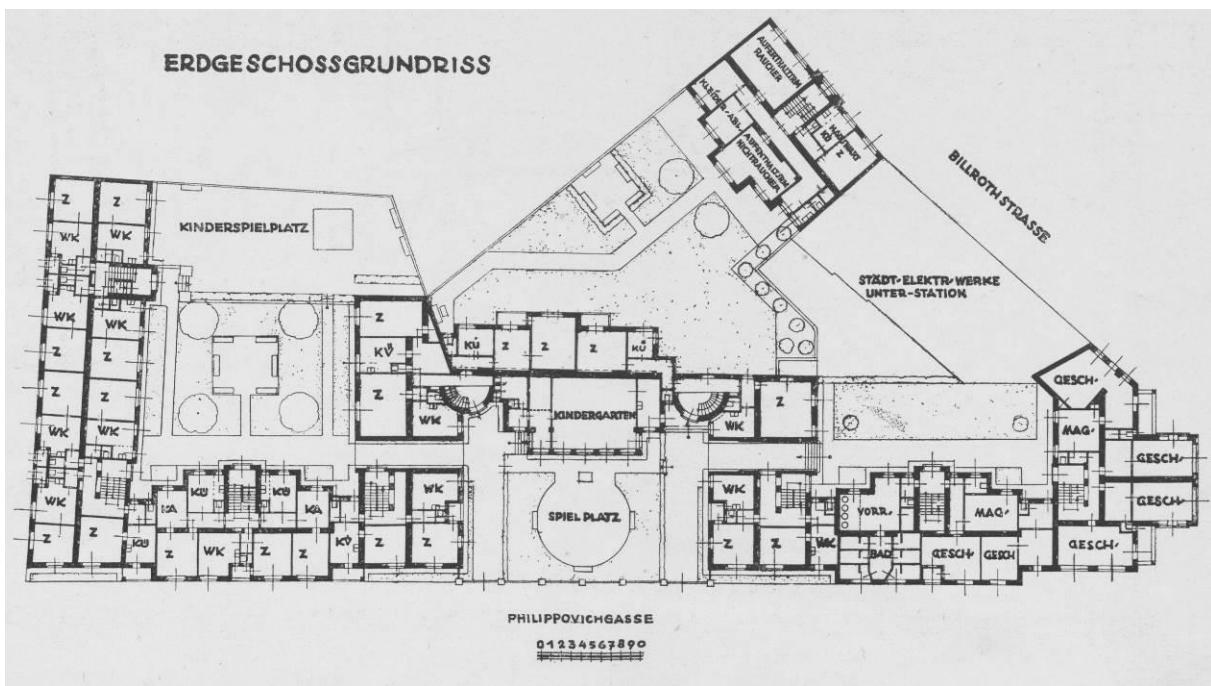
Wohnanlage Pestalozzihof, Wien, Geschossgrundrisse, um 1926.
